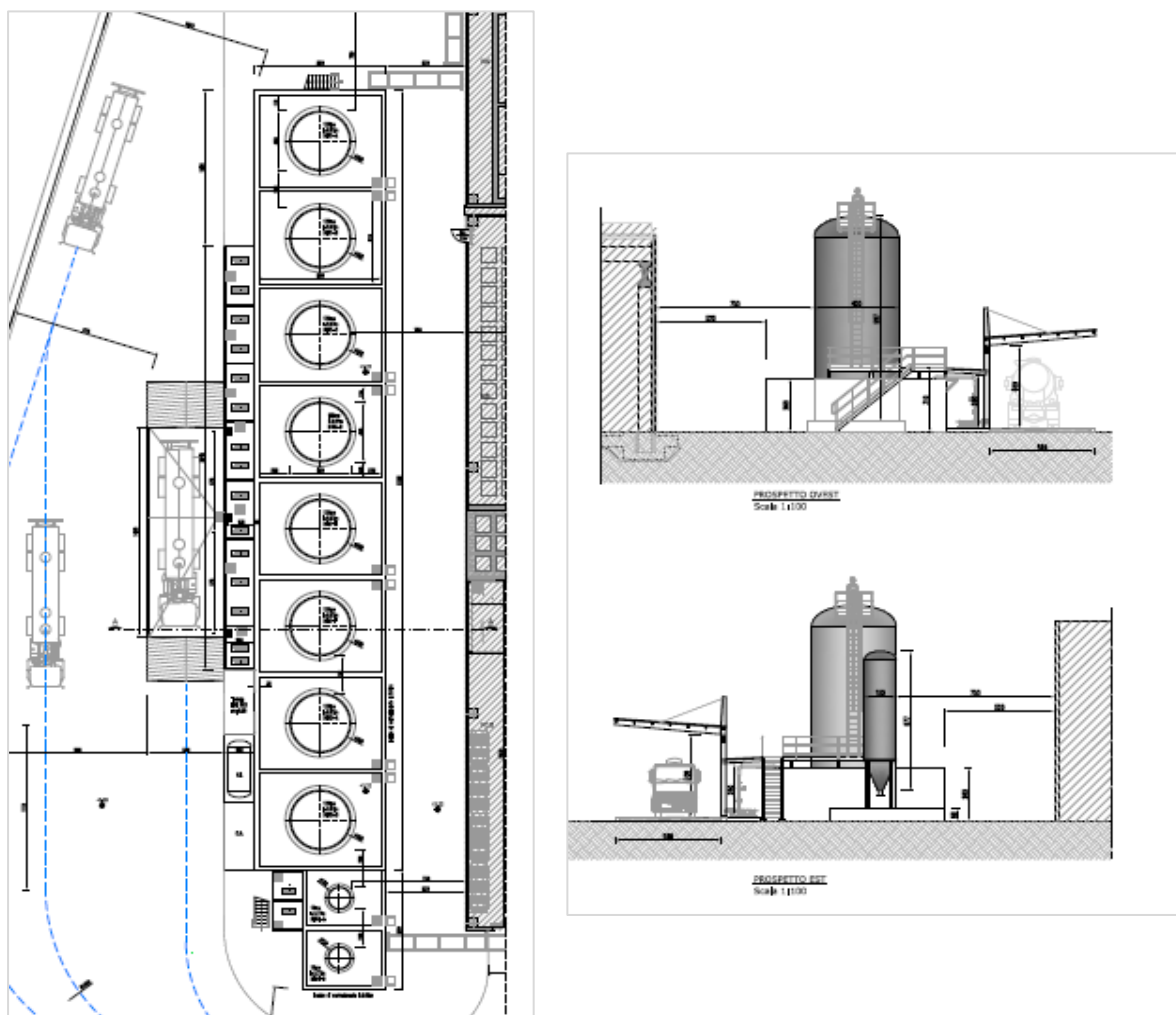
Dettaglio localizzazione Sezione N9 (dx) e prospetti EST/OVEST (sx) (Stralci elaborati CO 05 RA VA 00 D1 PL 54.00 - N9 PIANTE e CO 05 RA VA 00 D1 PL 55.00 - N9 PROSPETTI E SEZIONI)
